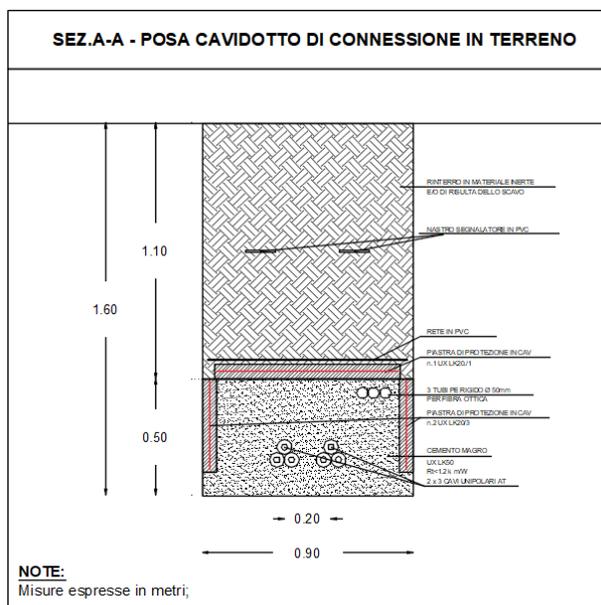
Tipologico di posa in terreno per il cavidotto di connessione
